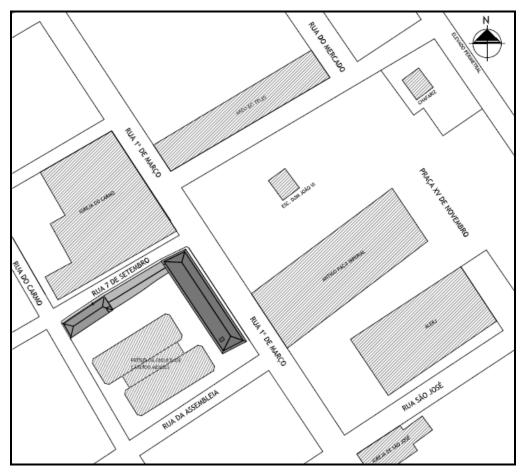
Planta de Situação do Antigo Convento do Carmo, blocos 01, 02 e 03. Fonte: Elaboração de Projetos Básico e Executivo para Restauração do Antigo Convento do Carmo, Planta Situação/Implantação/Cobertura, fevereiro 2014, Arquivo: 02_1310-Convento-01-ID-LEV-SIT-FNL
